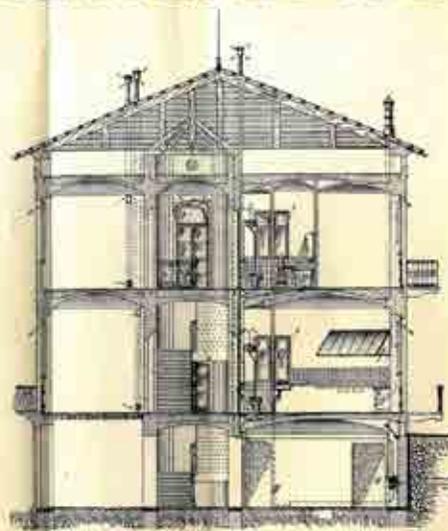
Sezione trasversale C-D (Scala 1:135)
